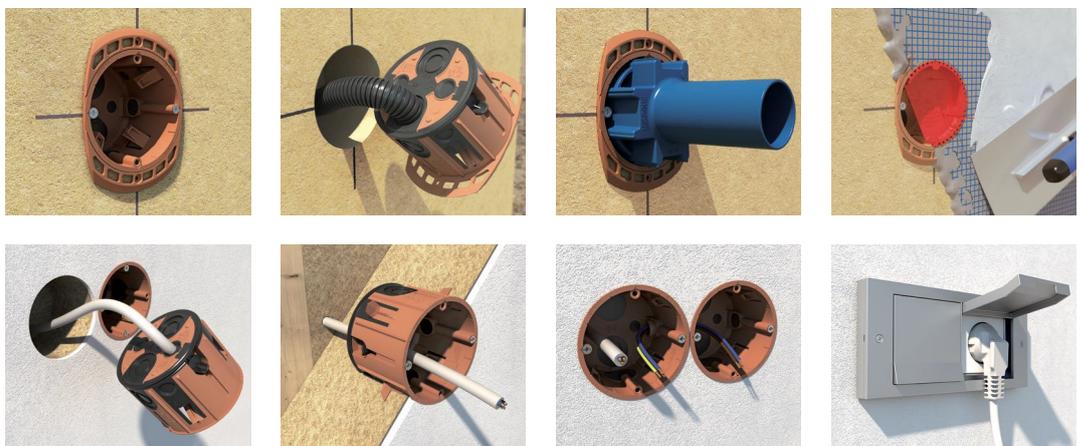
Geräte-Verbindungsboxen für die nachträgliche Installation in mitteldichten Holzfaserdämmstoffplatten
